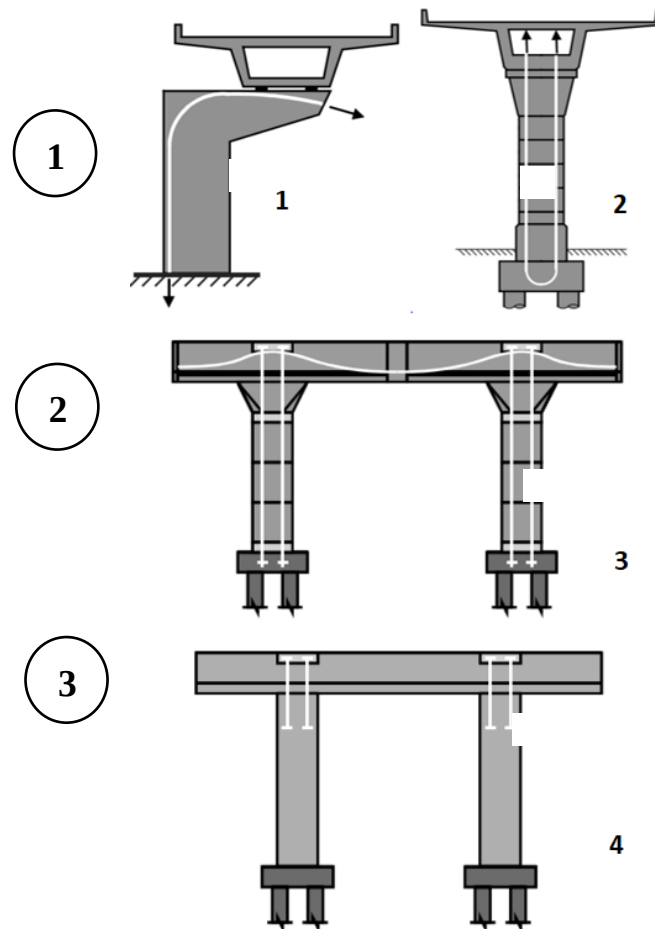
Aplicaciones del presfuerzo en subestructuras de puentes
